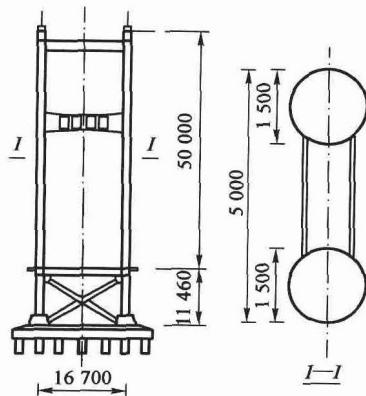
长山路大桥塔柱布置(尺寸单位:mm)
